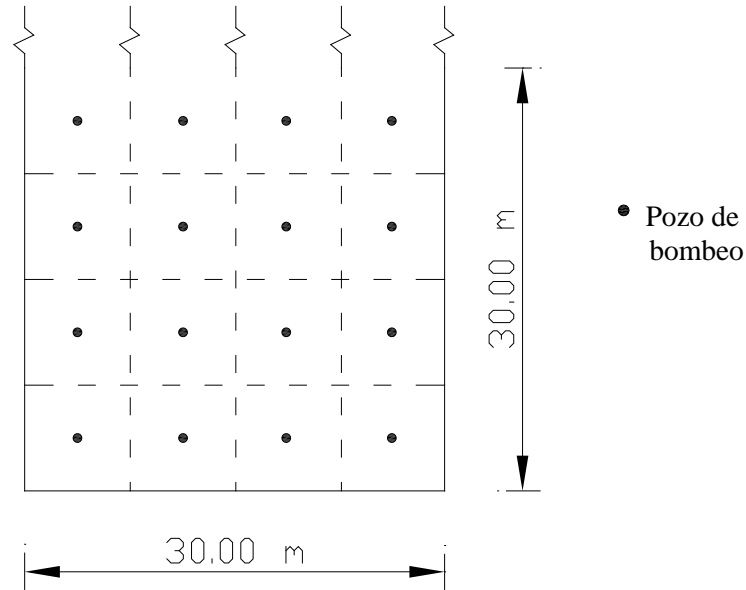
Esquema en planta de un sistema de bombeo para una excavación
